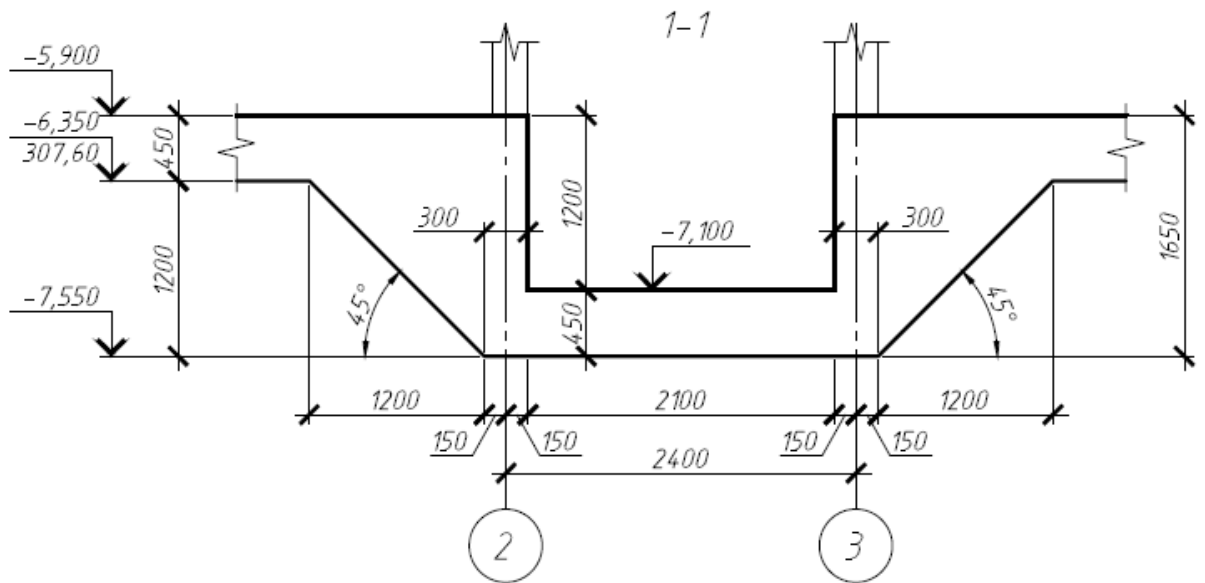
Поперечний переріз фундаментної плити у місці ліфтової шахти
